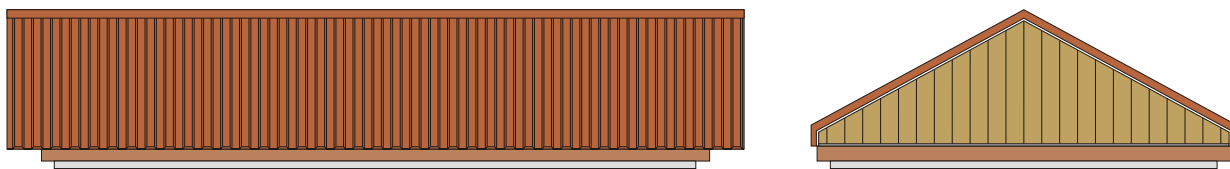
DACH W WARIANCIE „1” - DACH KOPERTOWY CZTEROSPADOWY (NAKLADKA NA STROPODACH), POKRYTY BLACHĄ TRAPEZOWĄ.
